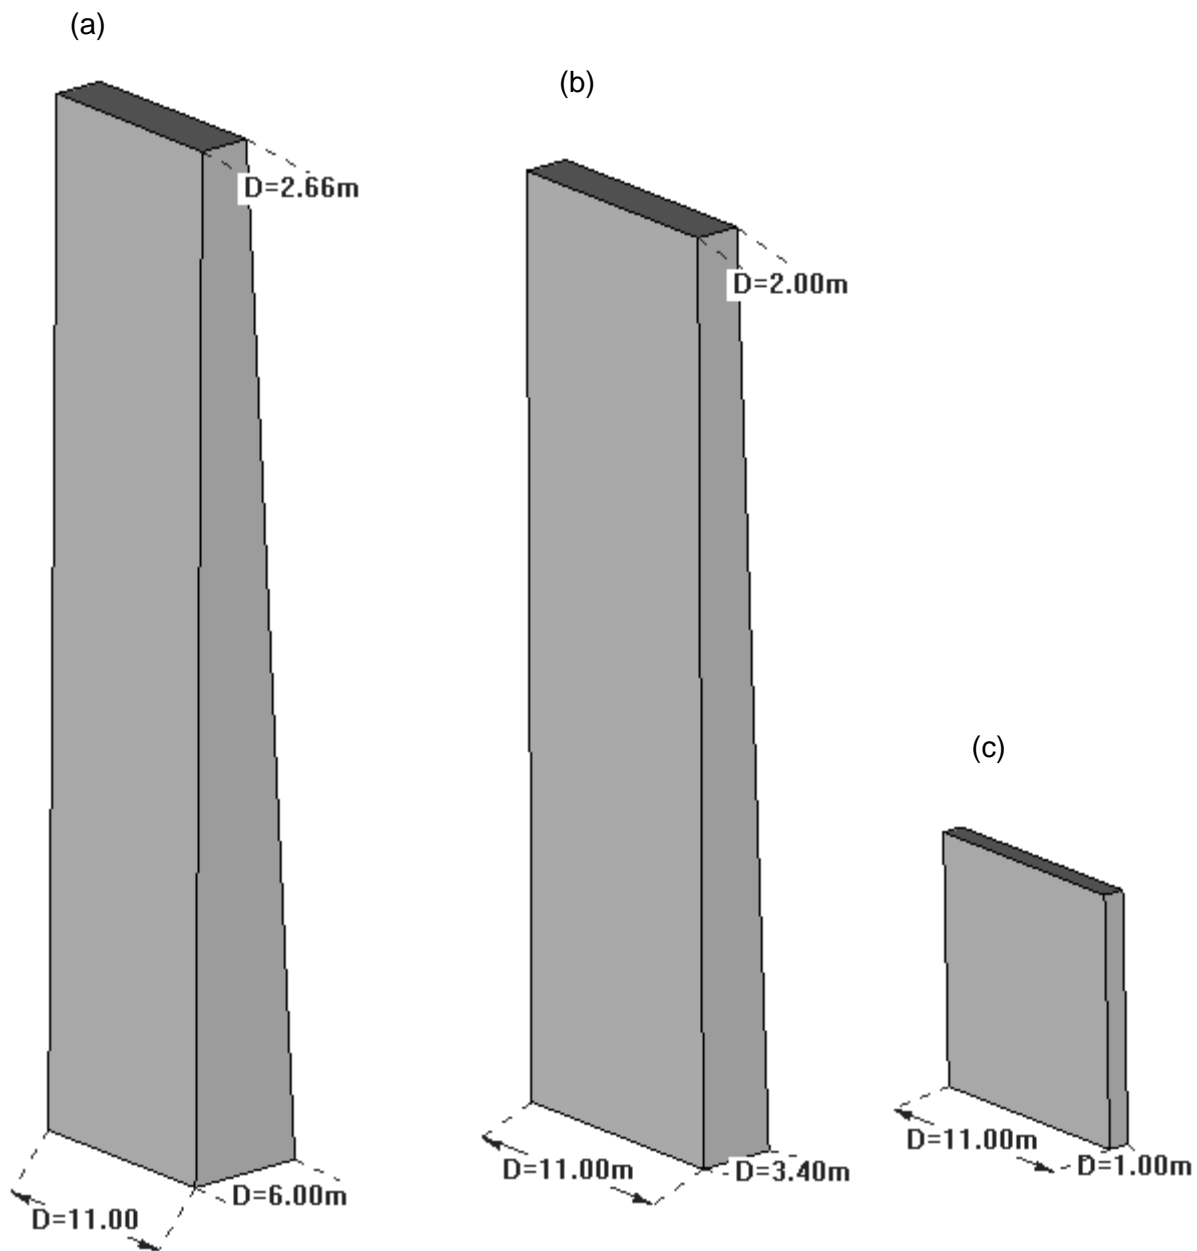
Figura (a), segunda columna. Figura (b) primer y tercer columna. Figura (c) cuarta columna.
